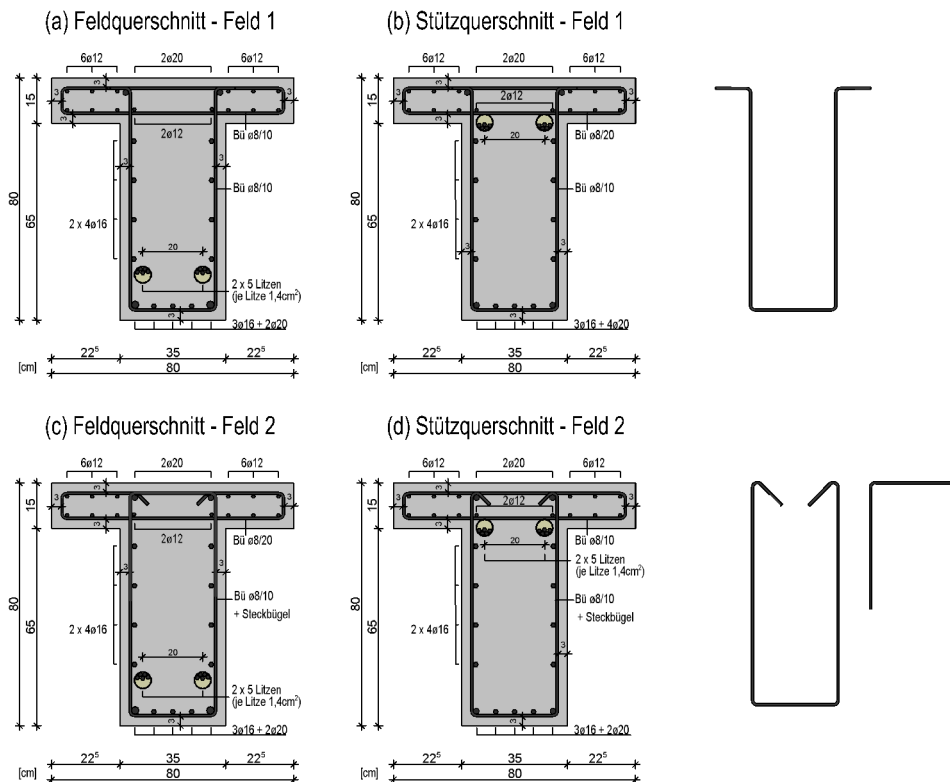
Bewehrung Querschnitt (Unterschiedliche Bügelbewehrung) DLT 8 aus [44]
